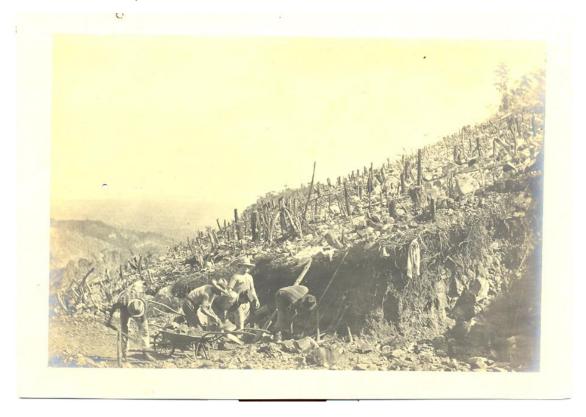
Vista desde Piedra Gorda del plano inclinado
